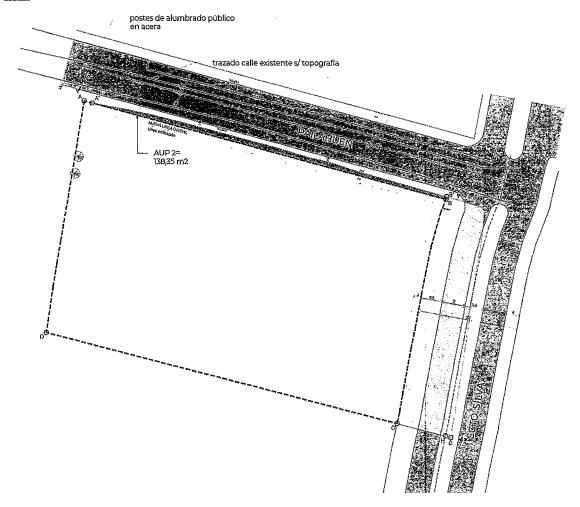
Situación propuesta de ajuste de trazado entre situación existente y el PRC Puerto Montt.
